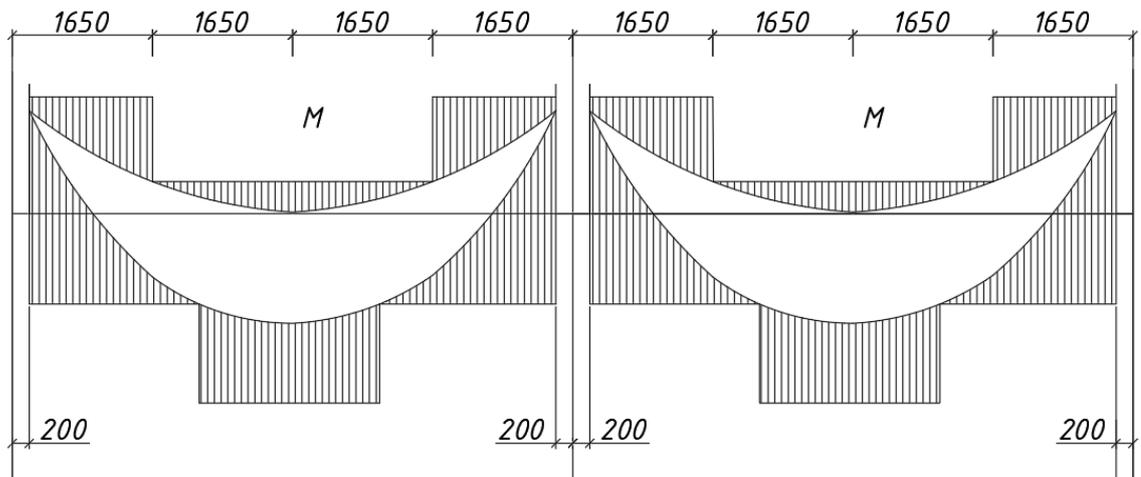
Расчетная схема фрагмента плиты перекрытия с опирание на колонны по четырем сторонам, определение максимальных действующих моментов
